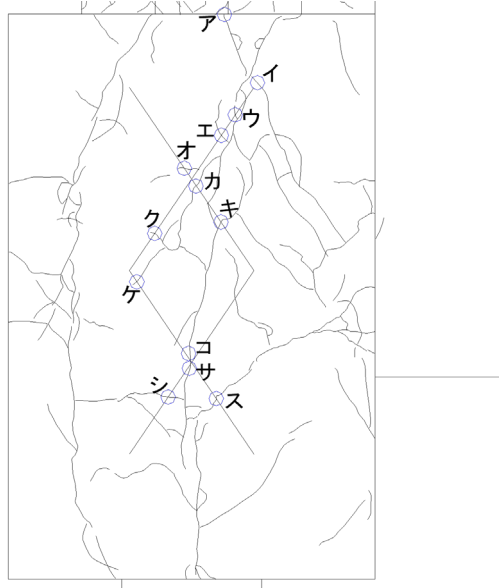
200 パイルキャップひび割れ幅測定位置 (試験体 A-2 正載荷)
